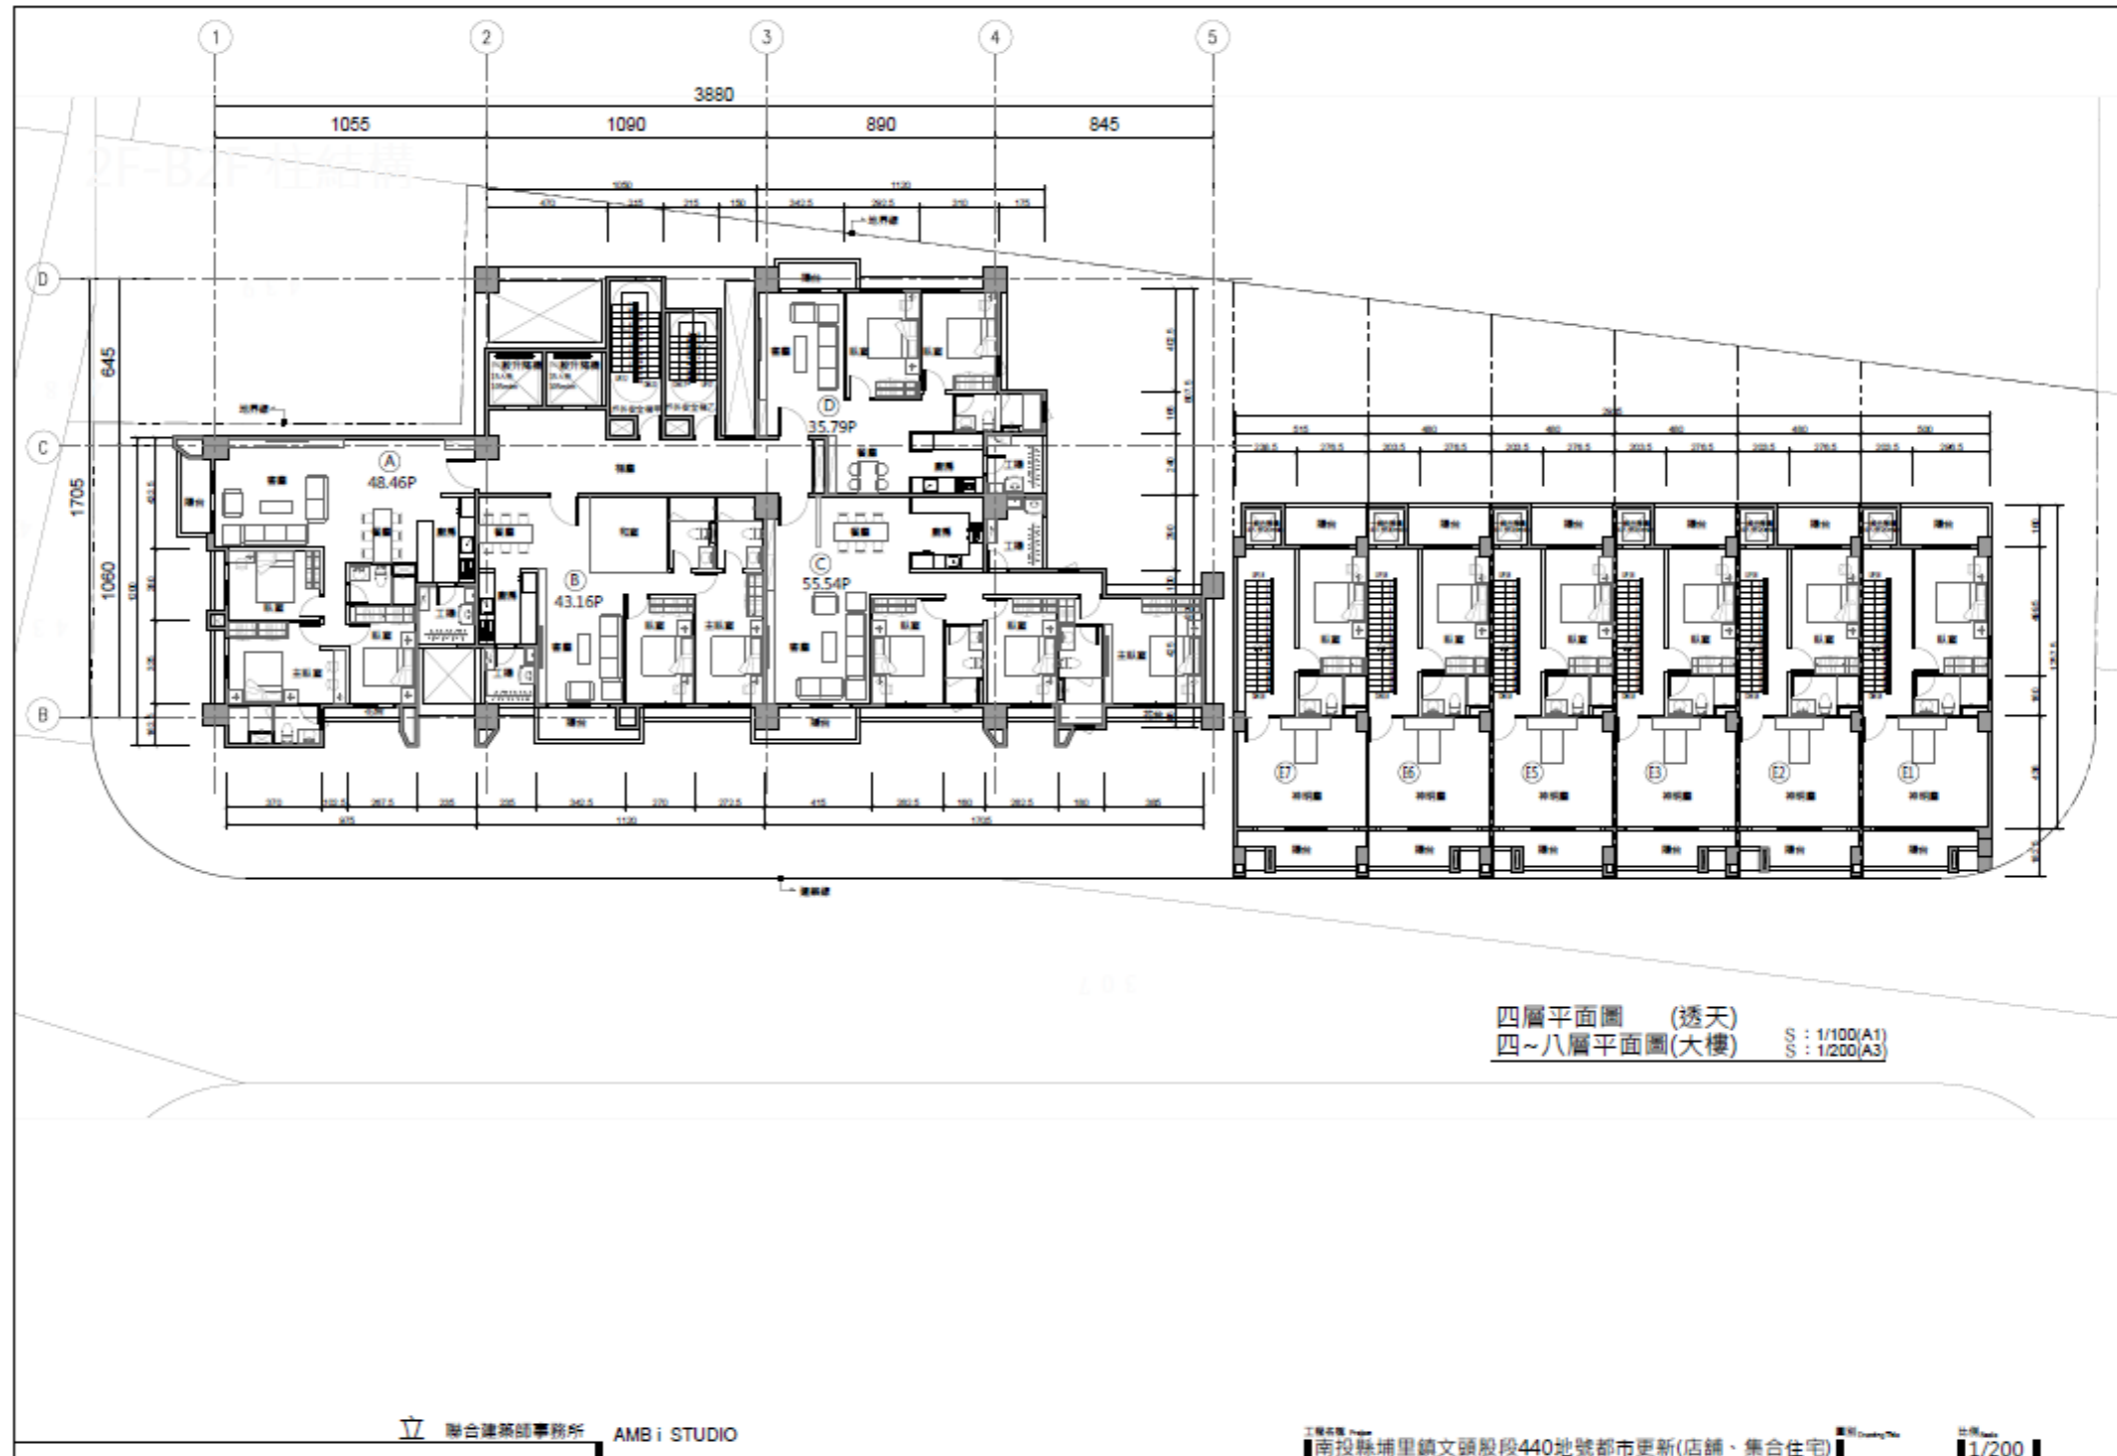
四層平面圖 (透天)、四~八層平面圖 (大樓)
